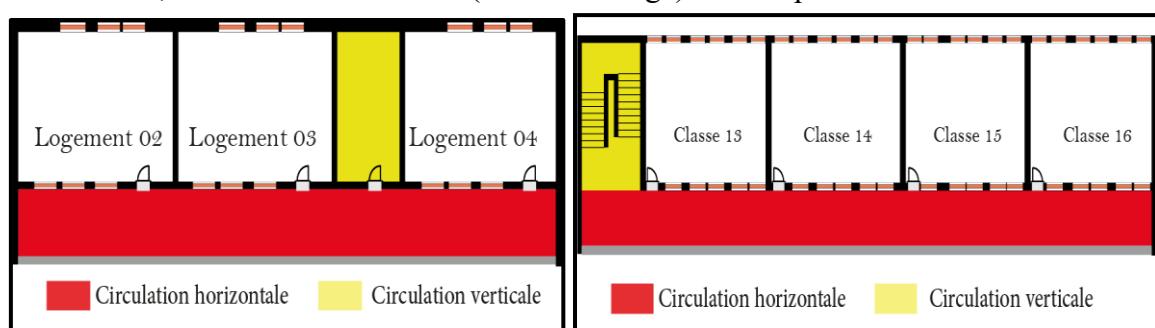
plan de 1 étage de l'école 2 (traité par l'auteur)
